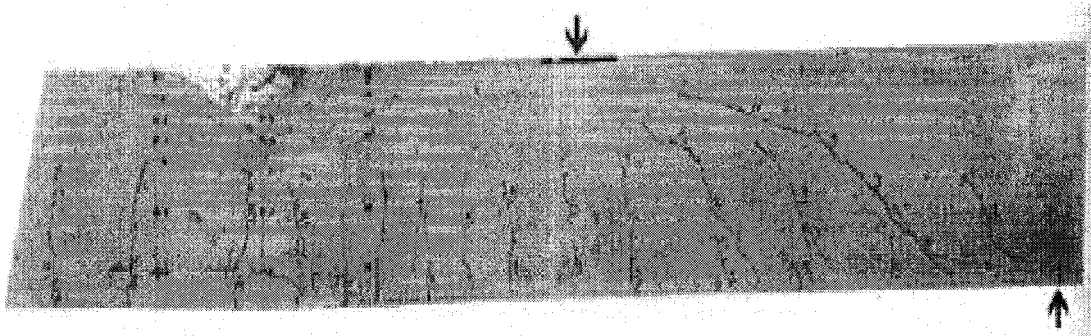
Réseaux de fissures de flexion et de cisaillement dans une poutre rectangulaire. (Adaptée de MacGregor et Bartlett, 2000)
